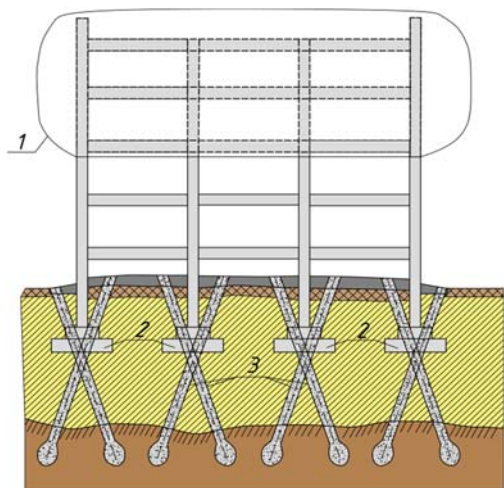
Усиление основания фундаментов для случая надстройки этажей: 1 – надстраиваемая часть; 2 – существующий фундамент мелкого заложения; 3 – буринъекционные сваи ЭРТ (РИТ, ФОРСТ, ЭРСТ) усиления
